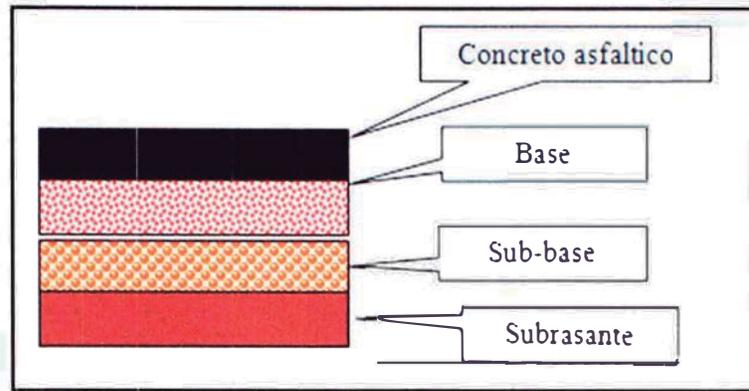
Estructura de un Pavimento Flexible.
